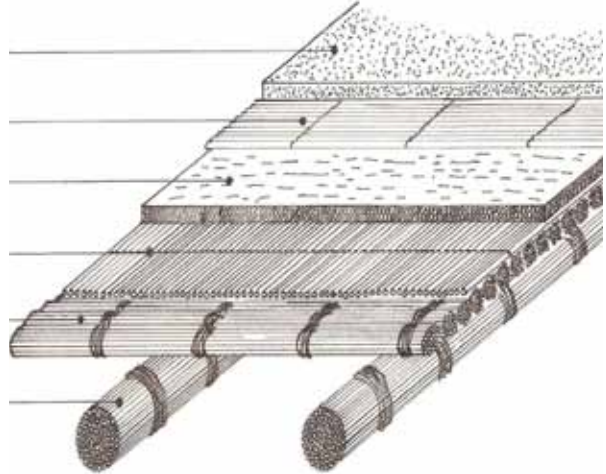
Struttura del solaio con con steli di canapa per il sistema Casa Coltivata
